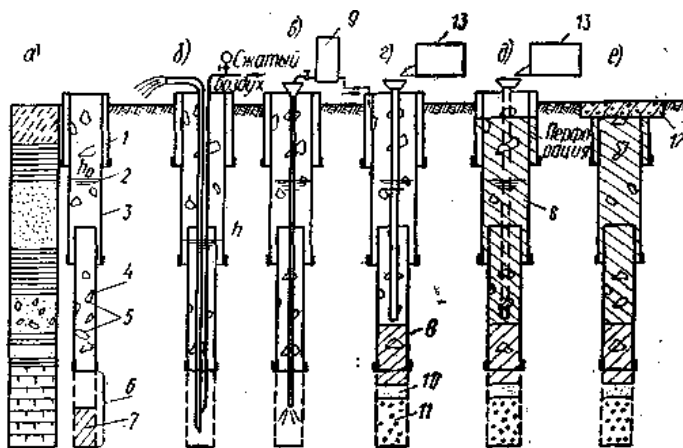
Схема санітарно-технічної закладення водяної свердловини: а - конструкція свердловини до тампонажу; б - промивка свердловини ерліфтної установкою; в - хлорування розчином хлорного вапна; г - заливка першої порції цементного розчину; д - заливка другої порції цементного розчину; е - бетонування шурфу і зрізів обсадних труб; 1 - колона обсадних труб; 2 - статичний рівень води; 3 - друга колона обсадних труб; 4 - третя колона обсадних труб; 5 - ознаки корозії отвори в обсадних трубах; 6 - робоча частина свердловини; 7 - замулення, засмічення; 8 - цементний розчин; 9 - обробка хлорним вапном; 10 - пісок; 11- фільтруючий матеріал; 12 - цементна плита; 13- бак для цементного розчину
